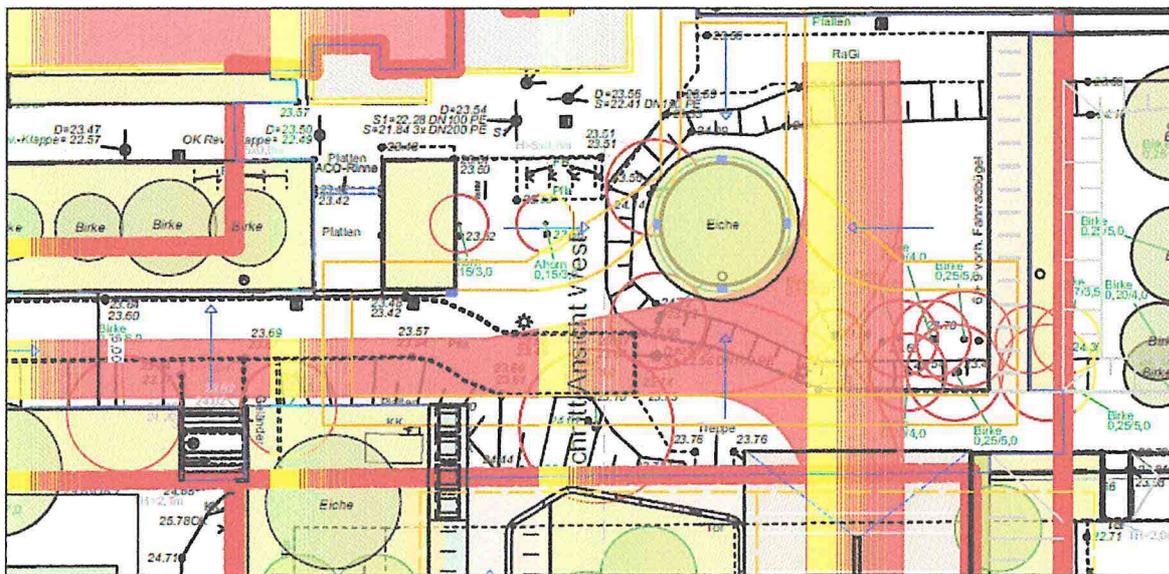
Darstellung der zu fällenden Bäume aufgrund des Straßenausbaus (Quelle: Entwurf Lageplan, 15.01.2021, ppp architekten + stadtplaner gmbh, Hamburg)
